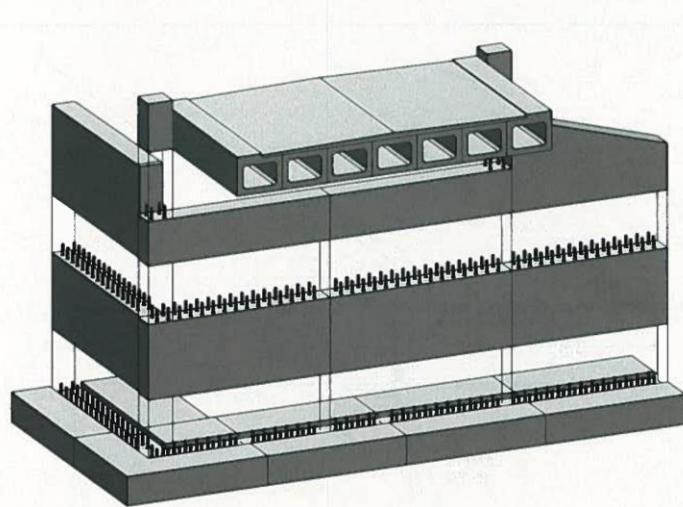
Concept des culées préfabriquées du pont d'Epping (Stamnas & Whittemore, 2005)
